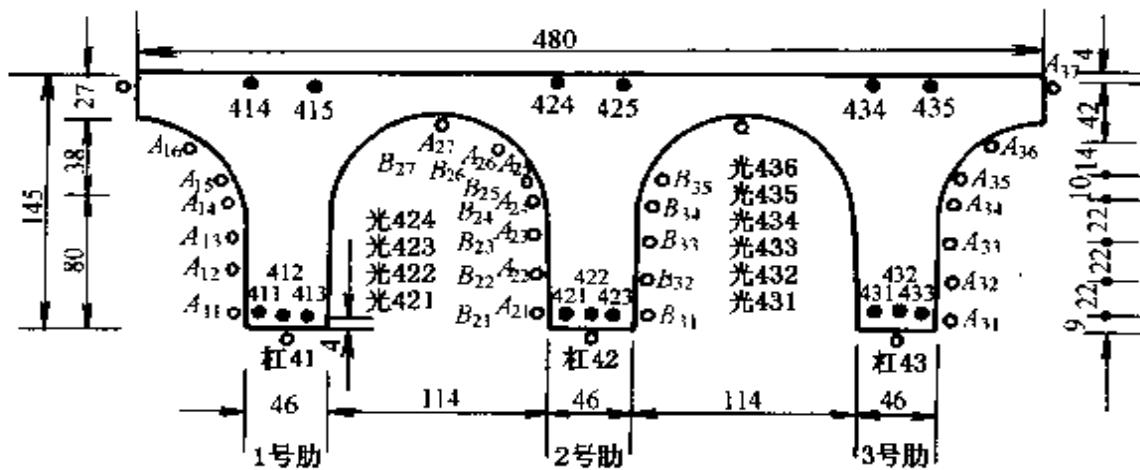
拱顶断面的测点布置(尺寸单位:cm)
